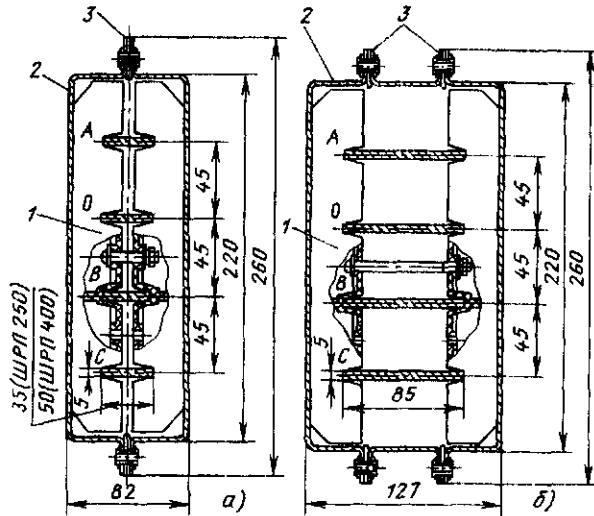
Поперечное сечение шинопроводов ШРП:
